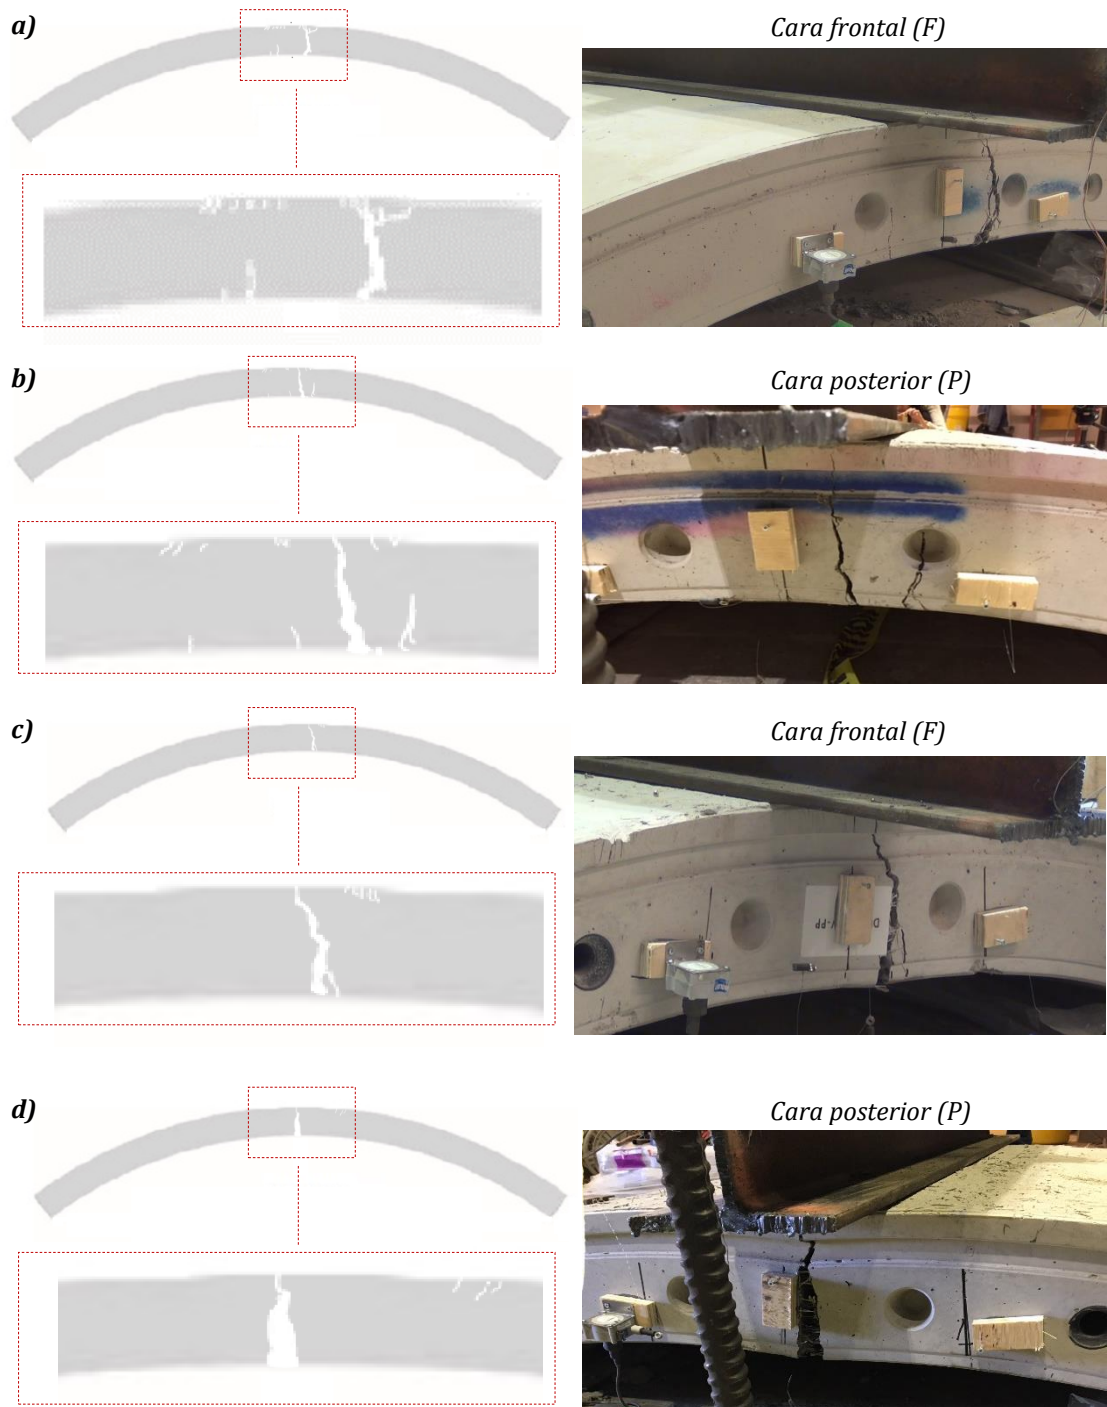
Mapa de fisuración y fotografía de la Dovela: (F) reforzada con fibra metálica a). (P) reforzada con fibra metálica b). (F) reforzada con fibra plástica c). (P) reforzada con fibra plástica d).
